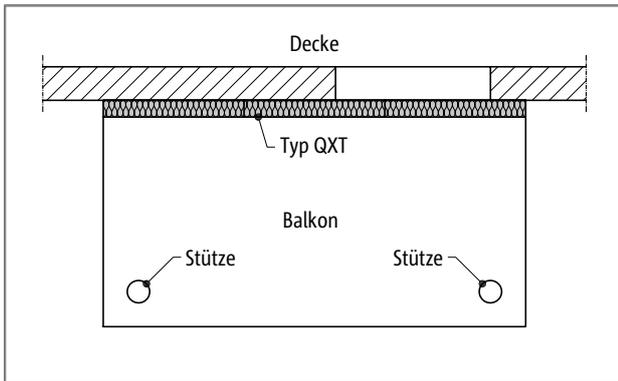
Schöck Isokorb® Typ QXT: Balkon mit Stützenlagerung
